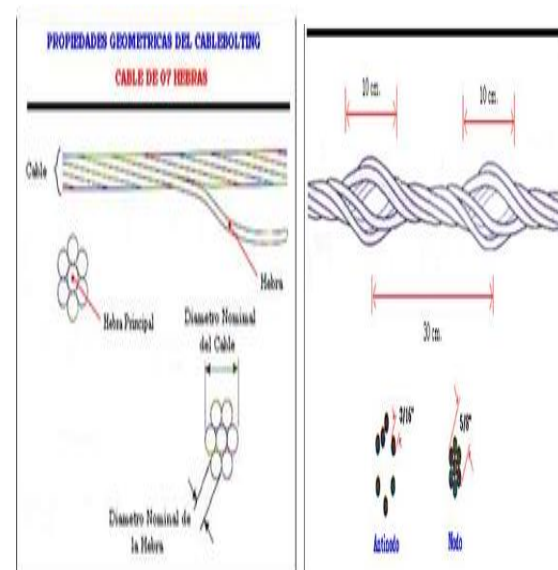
Propiedades geométricas del cable bolting (Mucha A. , 2019).
